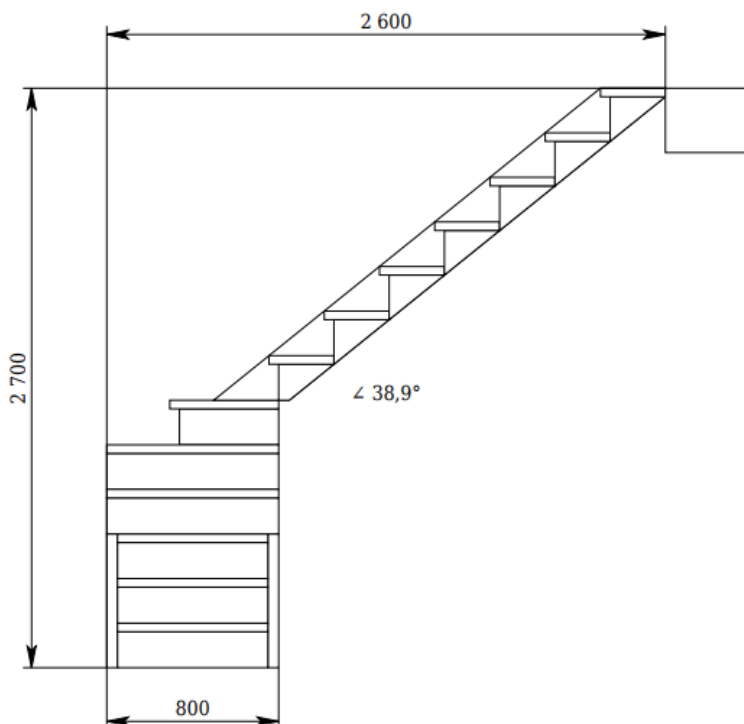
Лестница с забежными ступенями. Вид сбоку
